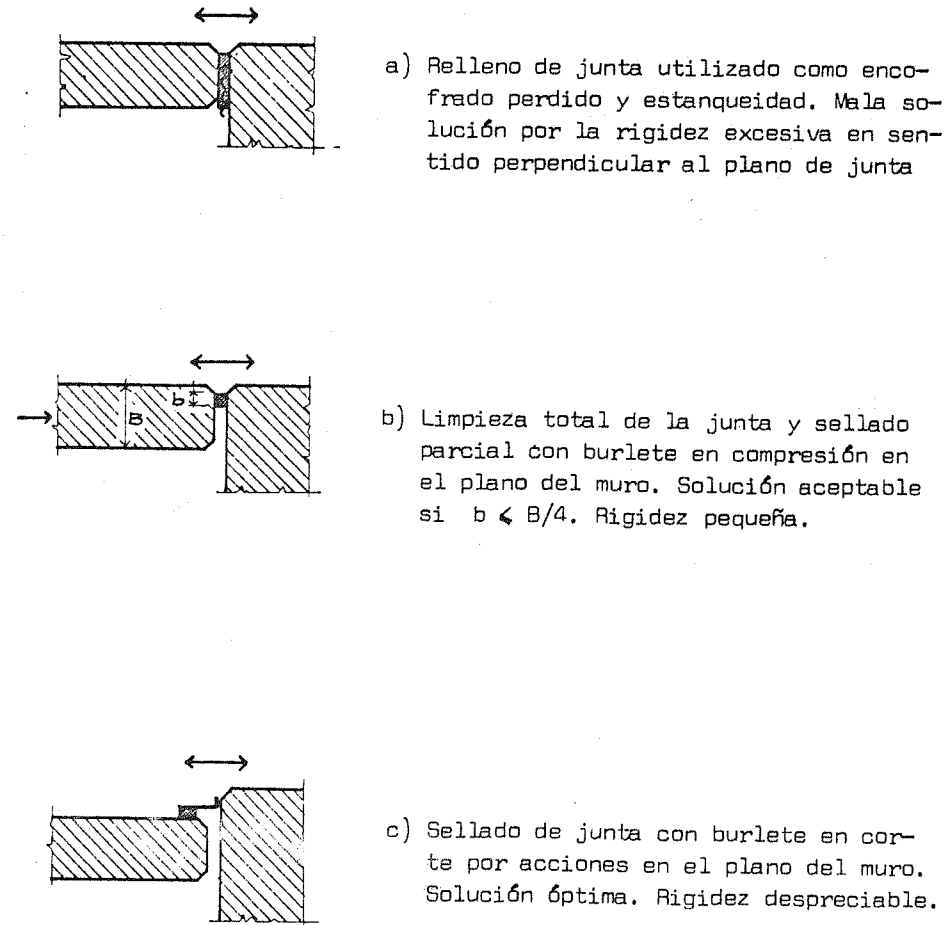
Posición de la estanqueidad y construcción de la junta
